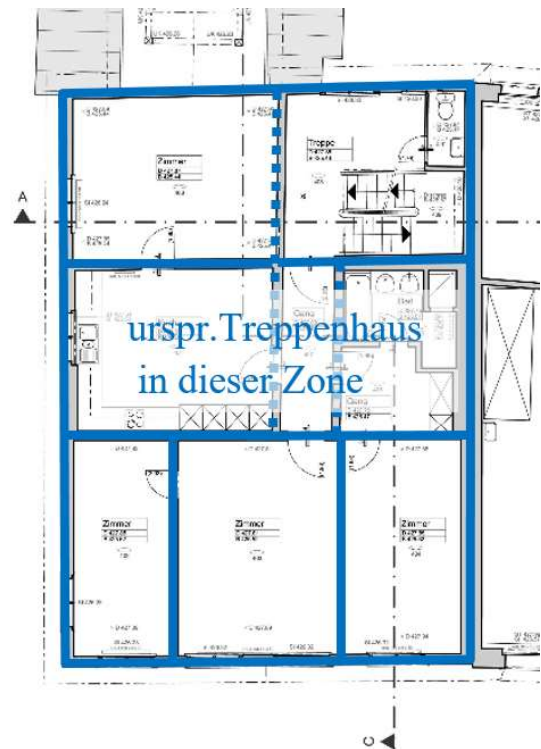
Grundriss 2. Obergeschoss mit schematisch eingetragenem bauzeitlichem Grundriss. Hier hat sich der einstige Grundriss weitgehend erhalten.
